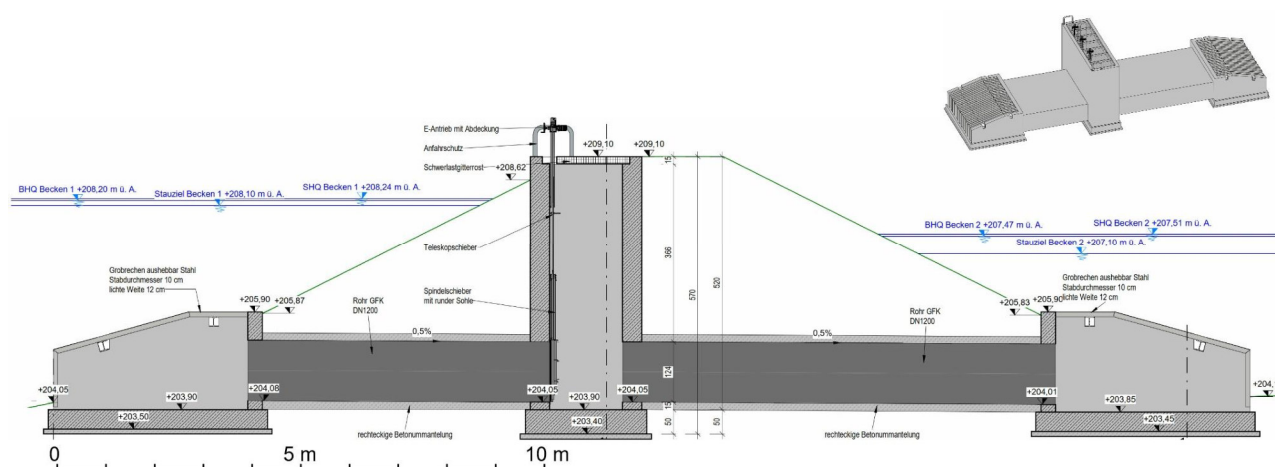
Längsschnitt durch das Trennbauwerk (Quelle: Einlage 027)
